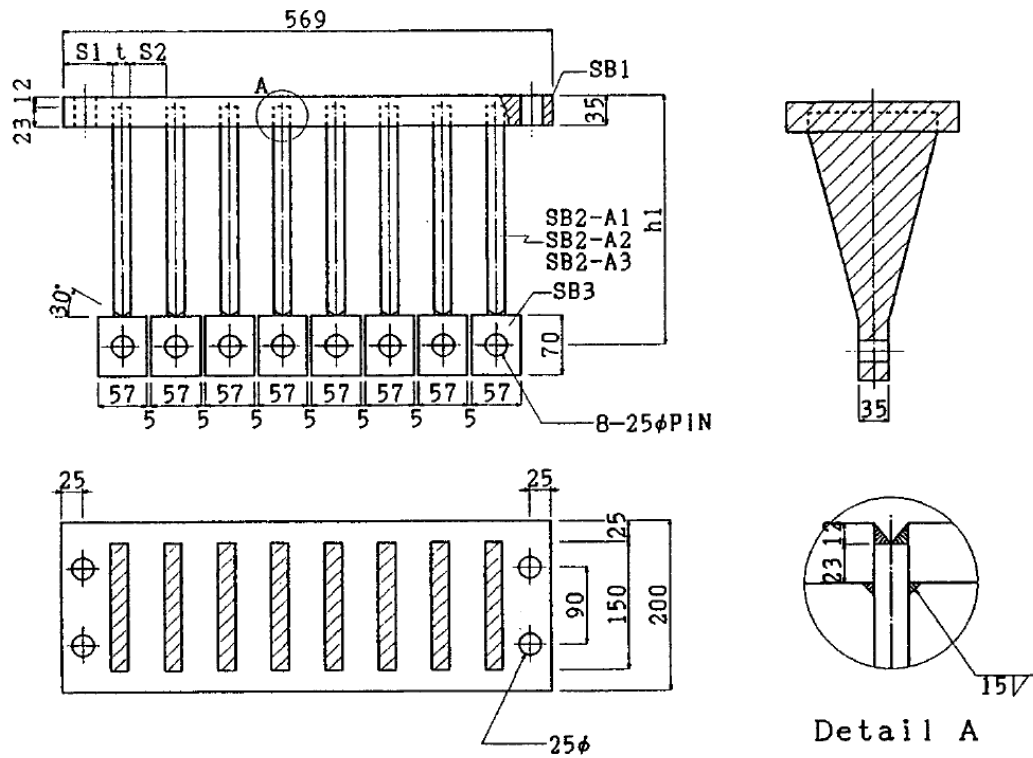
Detalles de dispositivo TADAS (unidades en mm) [12]
